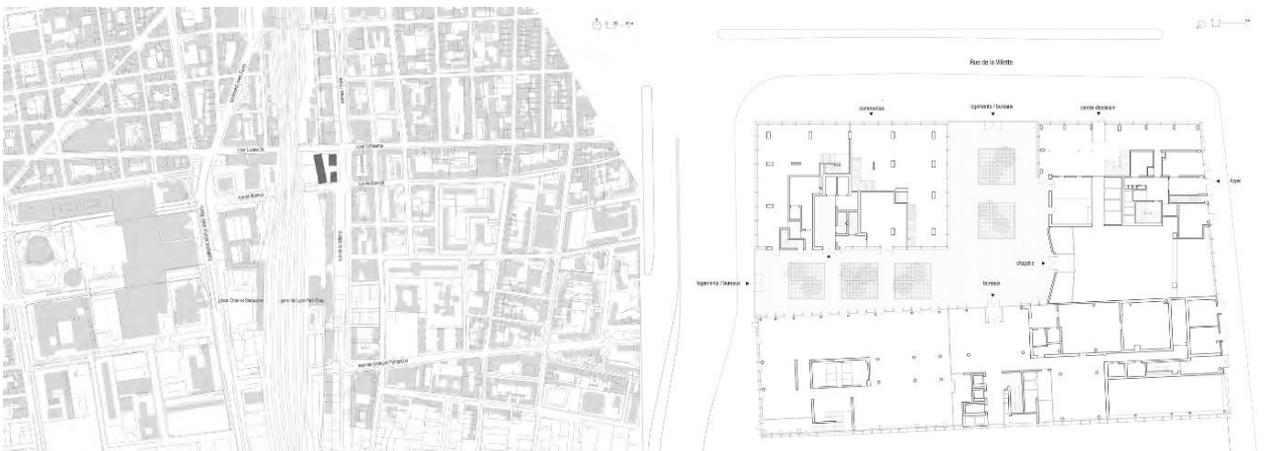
Жилой квартал социального жилья в Лионе, генеральный план и план первого этажа
